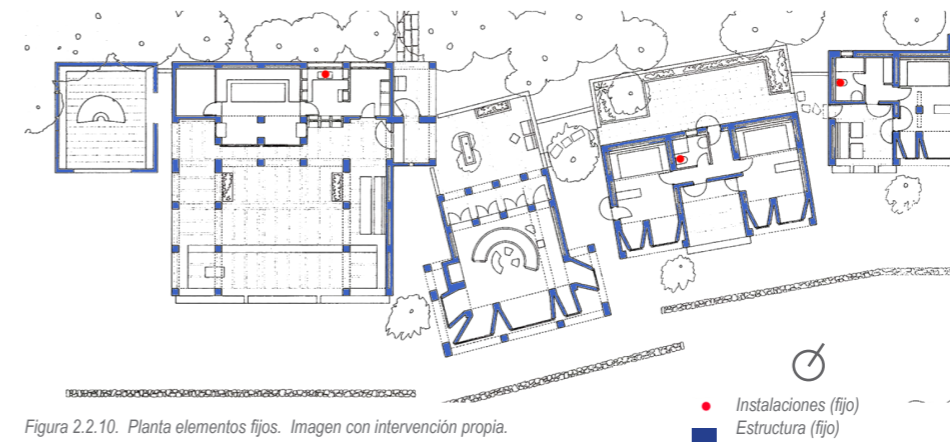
Planta elementos fijos. Imagen con intervención propia.
